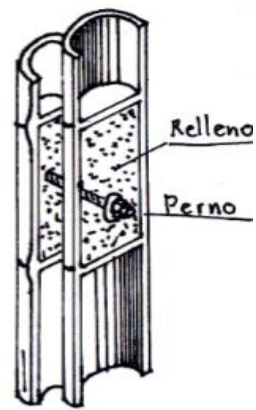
Detalle propuesto para la protección del elemento. Fuente:
